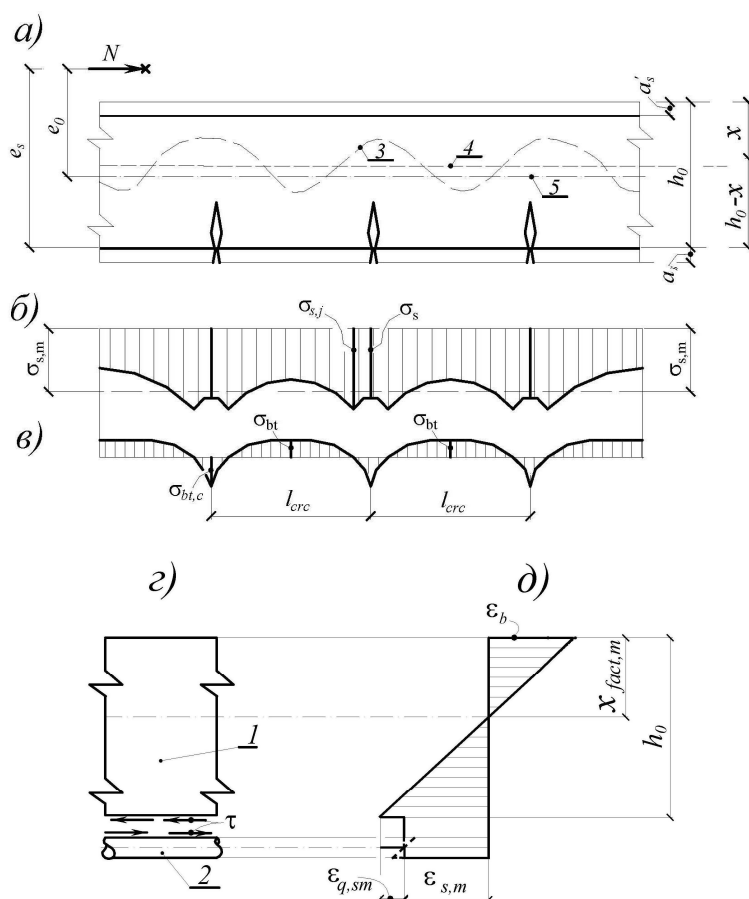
Картина трещин в средней зоне внецентренно сжатой железобетонной конструкции (а), эпюры деформаций арматуры (б) и бетона (в) на уровне оси растянутой арматуры, фрагмент железобетонной конструкции как составного стержня (г) и эпюра средних деформаций бетона и арматуры (д) в поперечном сечении составного стержня при учете средних условных сосредоточенных взаимных смещений бетона и арматуры
